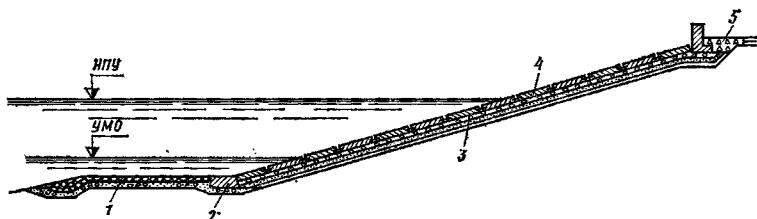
Пример конструкции откосного сборного сквазного крепления с применением железобетонных плит 1 — облегченное крепление; 2 — упор основного крепления; 3 — подготовка слоистая или однослойная; 4 — основное покрытие из плит с открытыми швами; 5 — засыпка из рядового щебня
